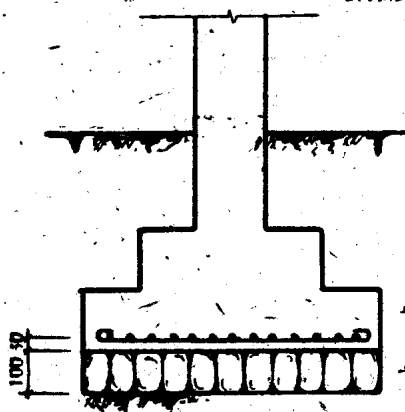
筑有碎石垫层的钢筋混凝土基础 (单位: mm)
